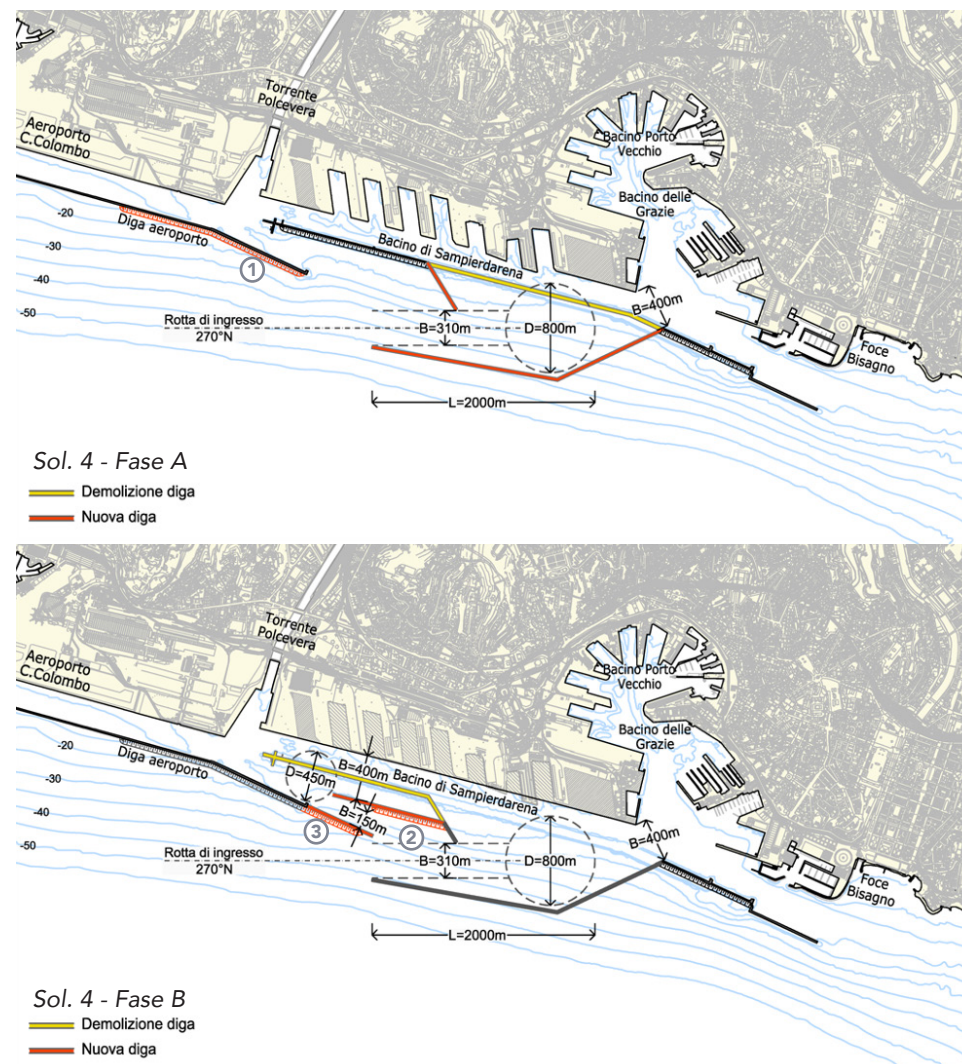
Soluzione alternativa d'intervento n. 4 – fasi funzionali a) e b) di costruzione
